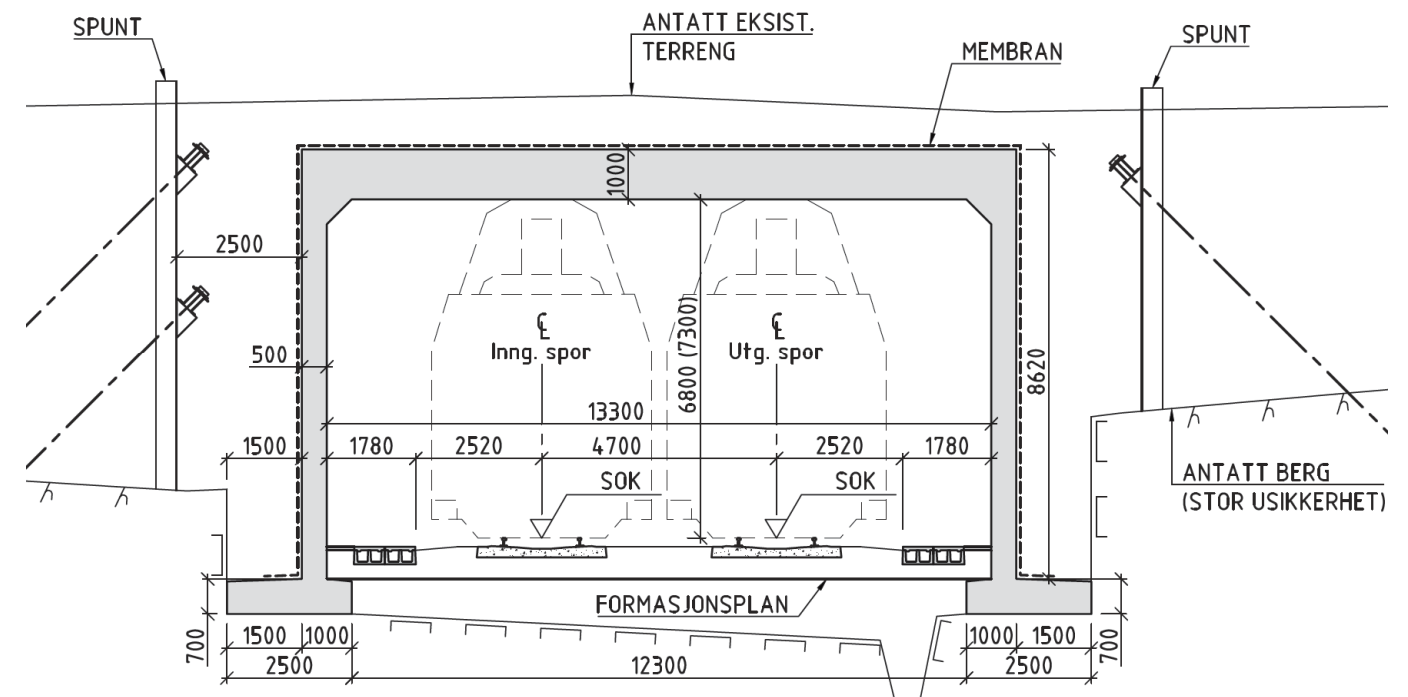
Typisk tverrsnitt for betongtunnel/portalkonstruksjon. Nivå for overfylling/eksisterende terreng varierer.
